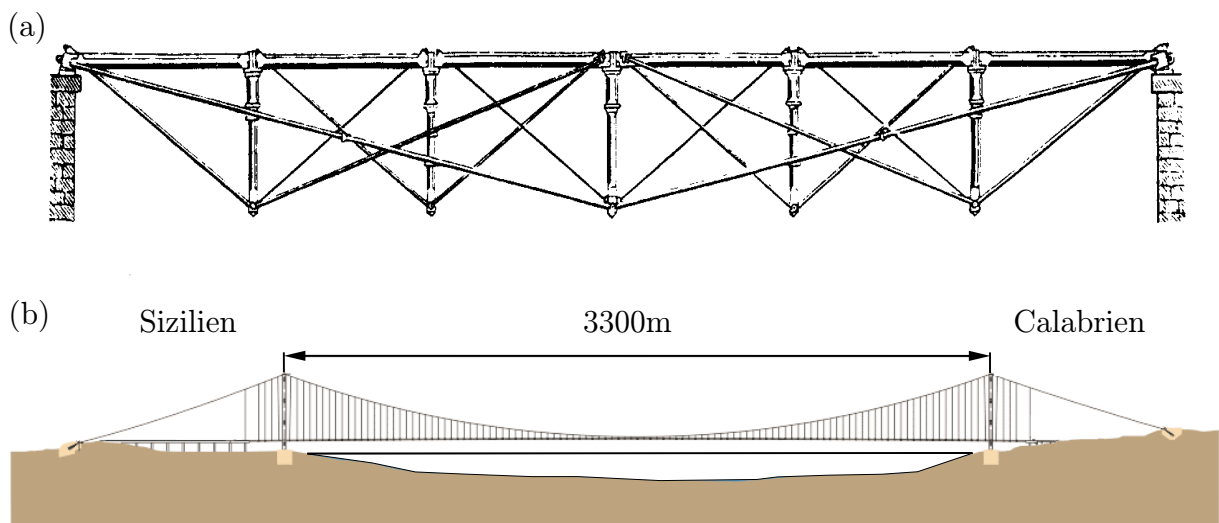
Brückenkonstruktionen in Leichtbauweise: (a) Fink-Truss 1871 (aus [36]); (b) geplante Hängebrücke über die Straße von Messina.
